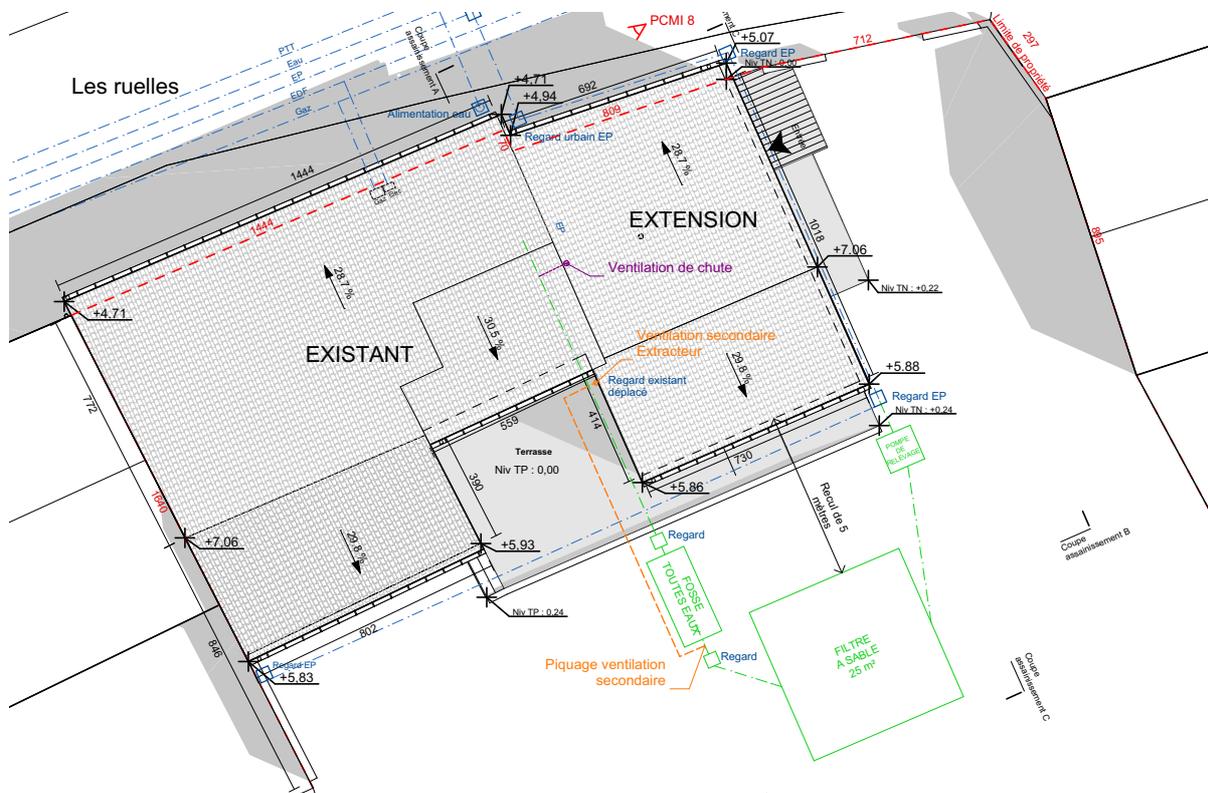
Plan de toiture avec filière assainissement - © Atelier MPA
